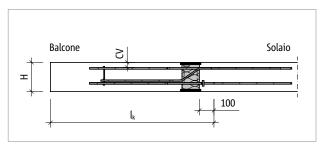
Schöck Isokorb® XT tipo CL: sistema statico
